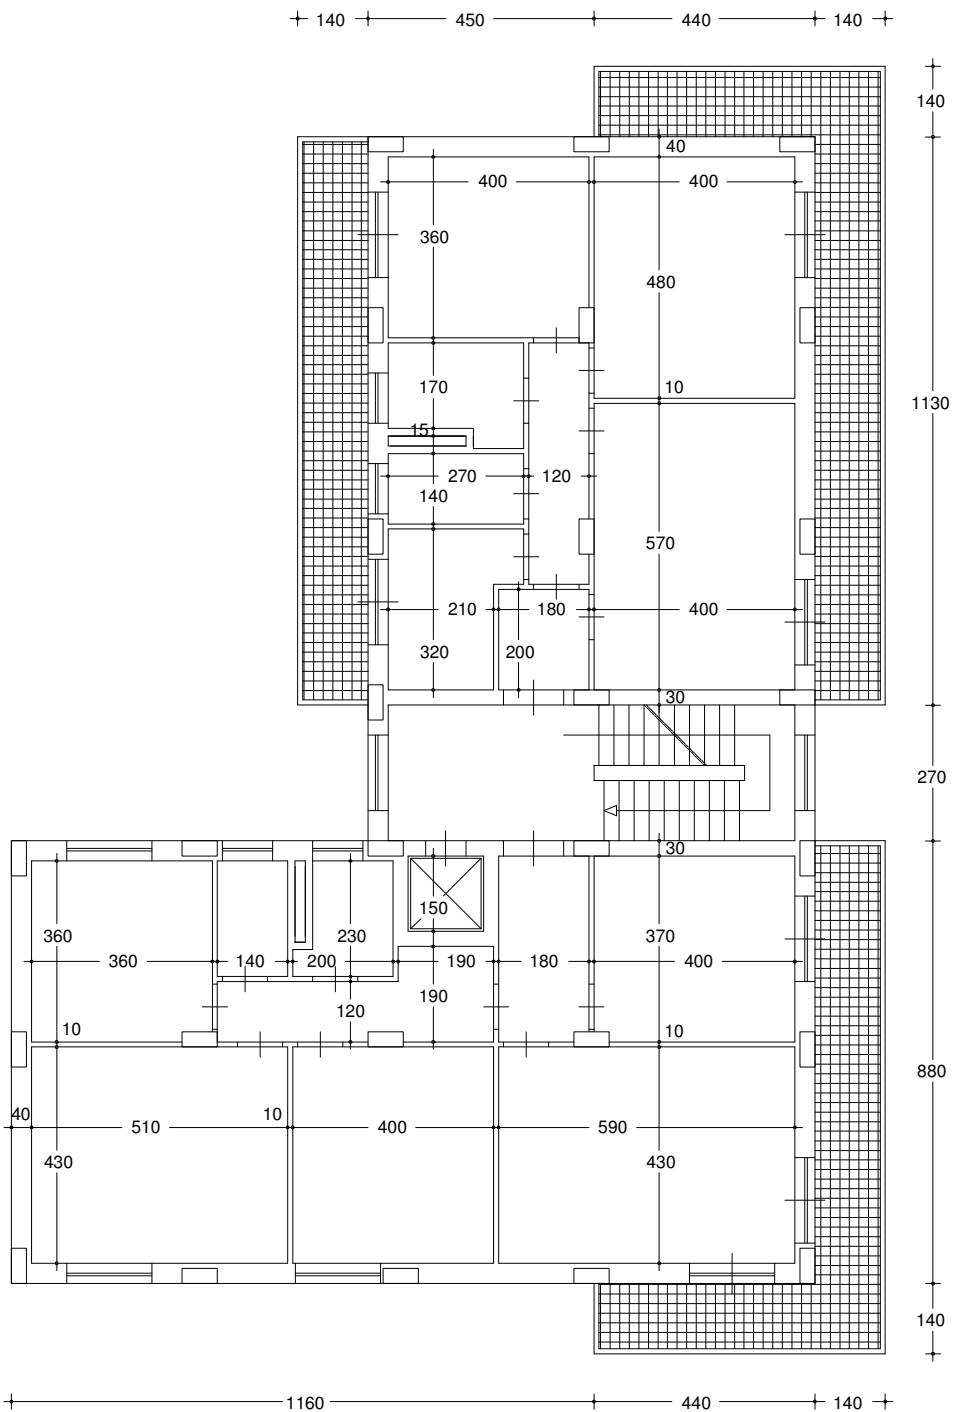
Pianta del piano tipo con indicazione dei pilastri
